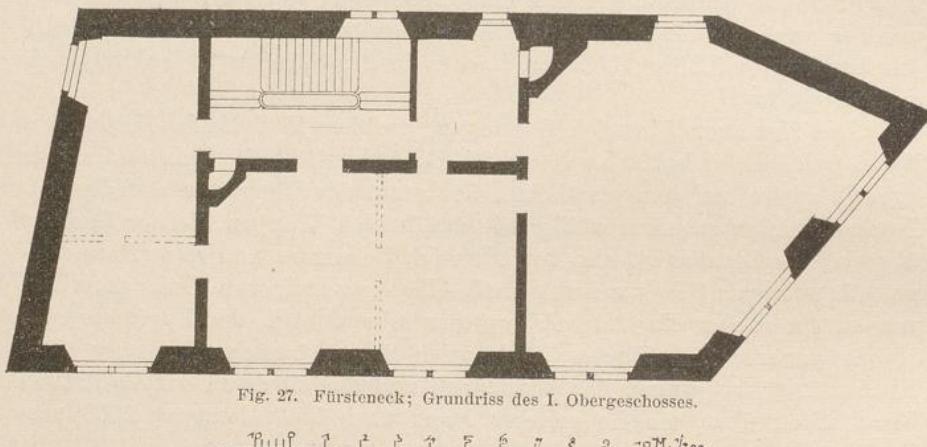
Fürsteneck; Grundriss des I. Obergeschosses.
